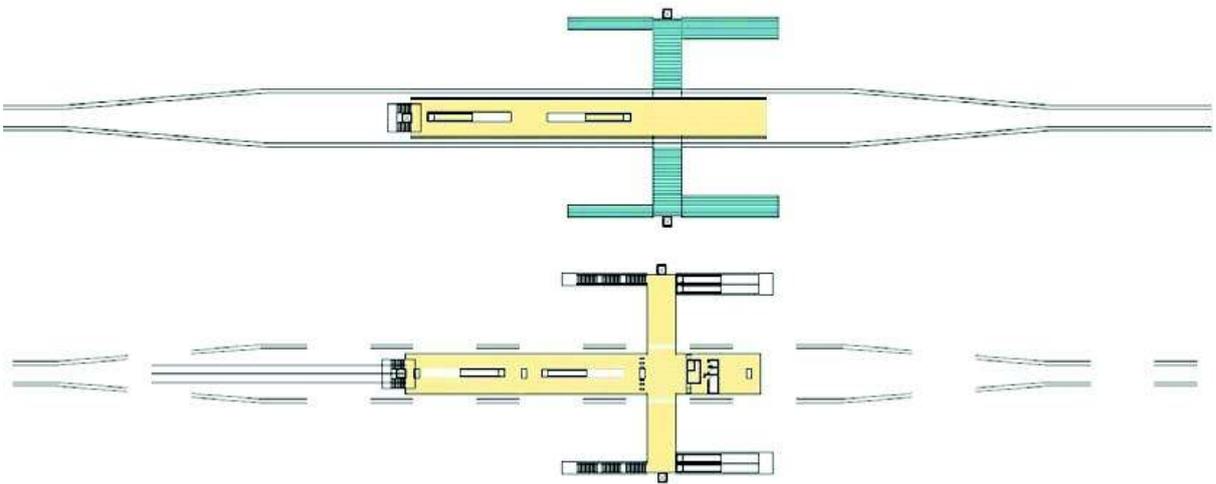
Desenho da Estação Padrão – Planta Baixa da Plataforma com os trilhos.
